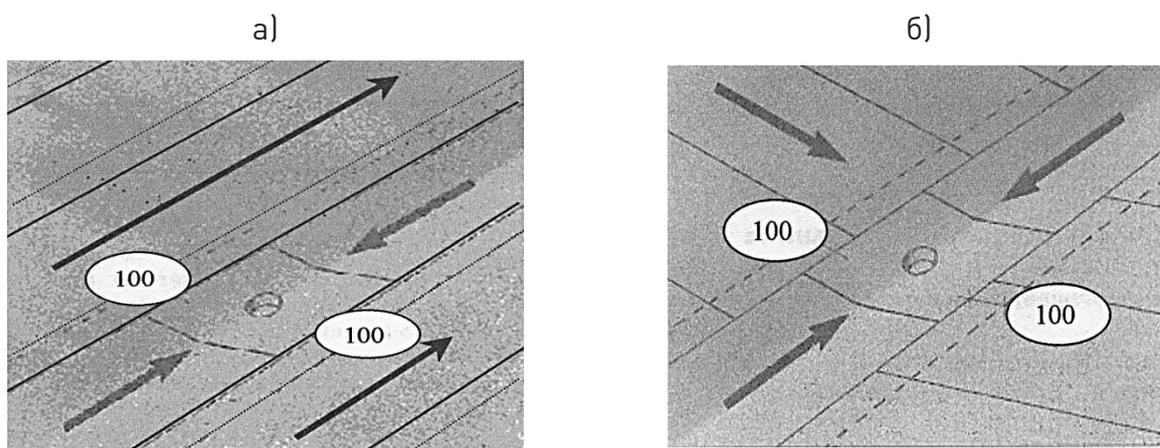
Направление раскладки рулонного материала на кровле с уклоном 10 % и менее (а) и на кровлях с большими уклонами (б)
